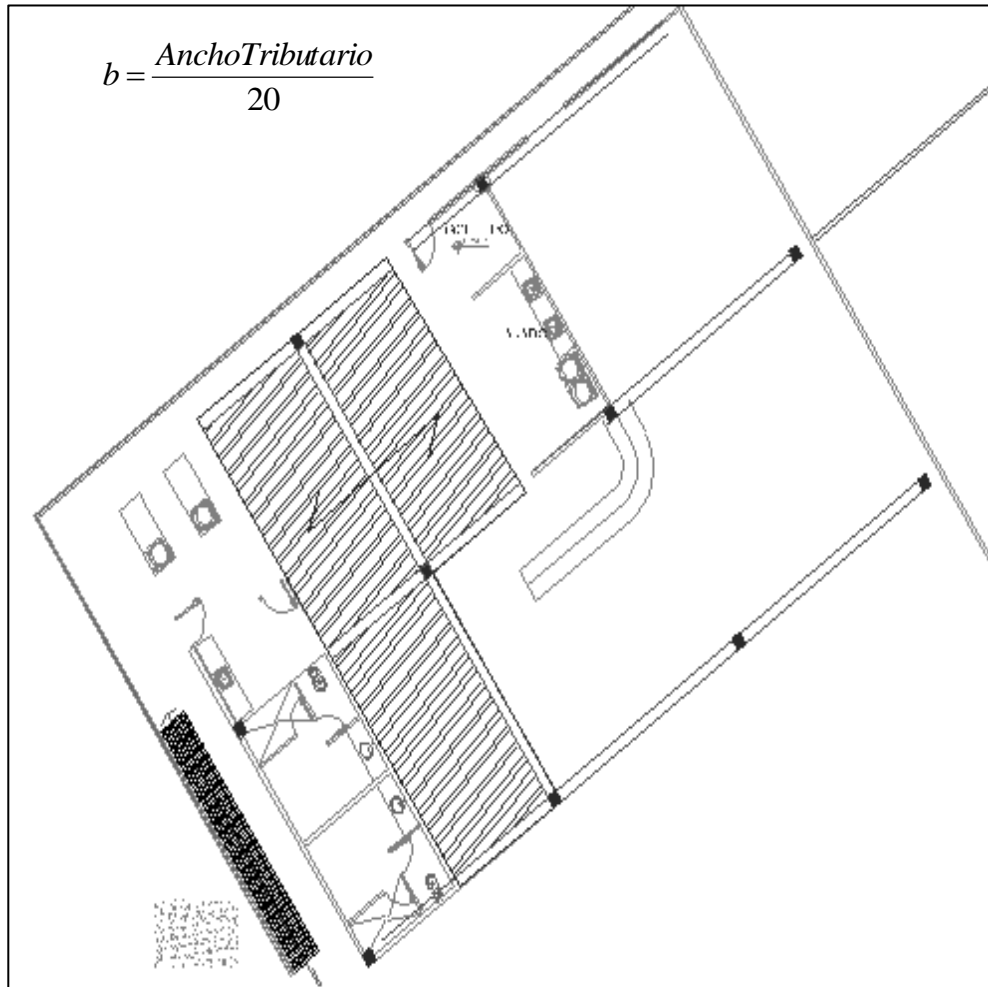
Plano estructuras restaurante vigas principales (Fuente: Elaboración Propia)
